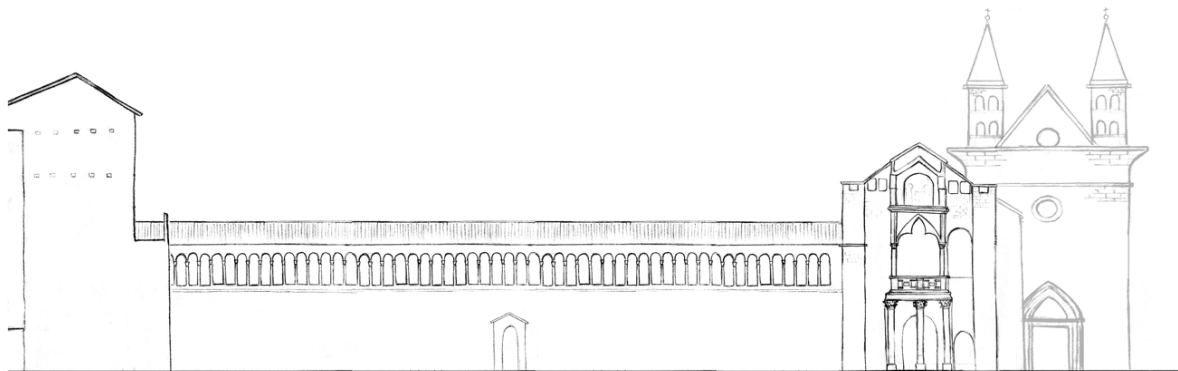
Reconstrucción de la fachada del Palacio de Letrán.
